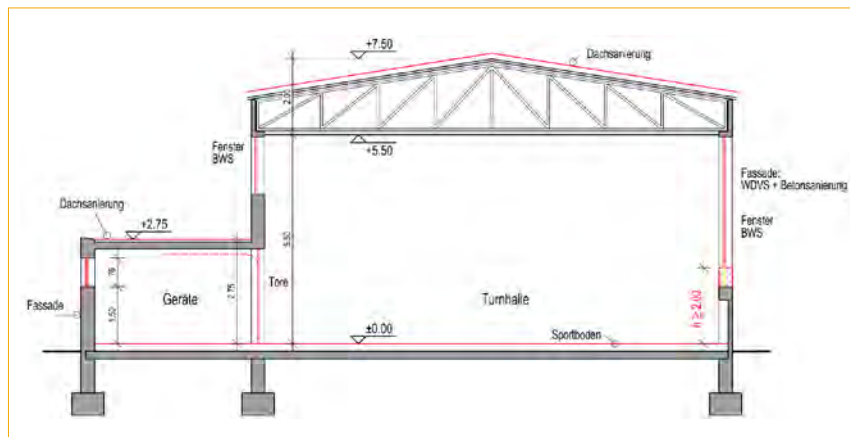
Hallenquerschnitt mit Bauteildarstellungen auf Grundlage der Bestandsunterlagen, Darstellung der geplanten Sanierungsmaßnahmen (rot) [Quelle: Arch. Peter Appel, Nordstemmen]
